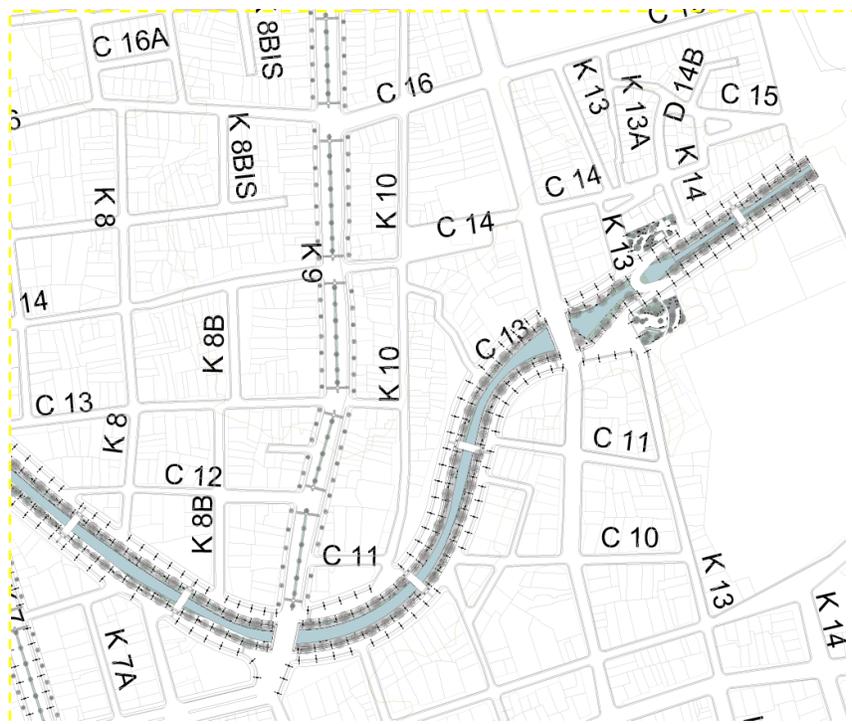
Plano General - Propuesta Urbana Sección 3
